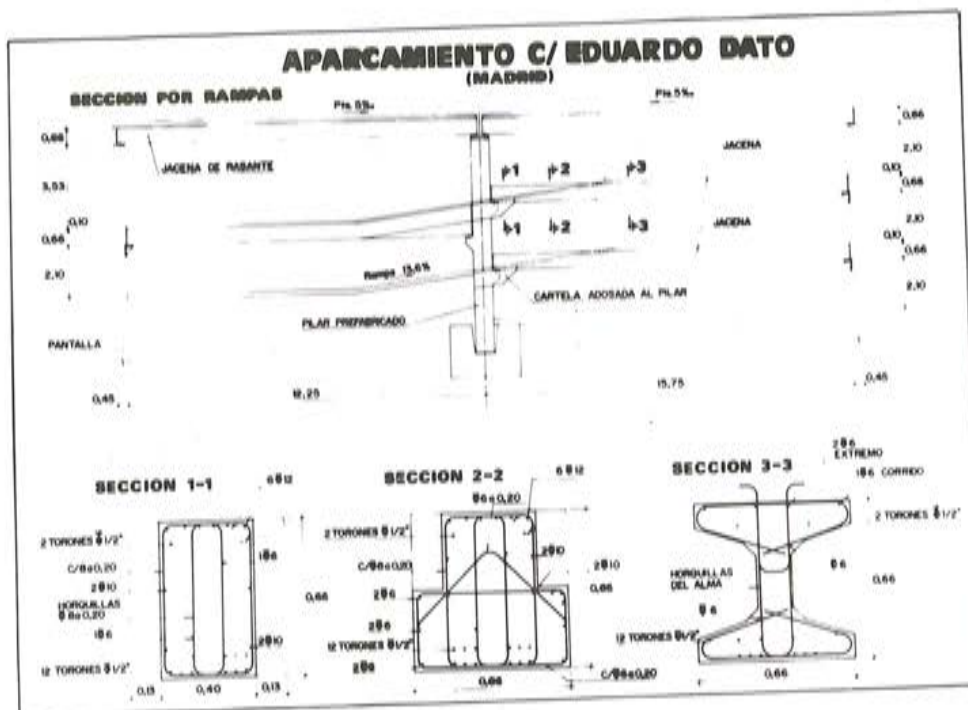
Sección por rampa. Detalle de la viga de rampa.
